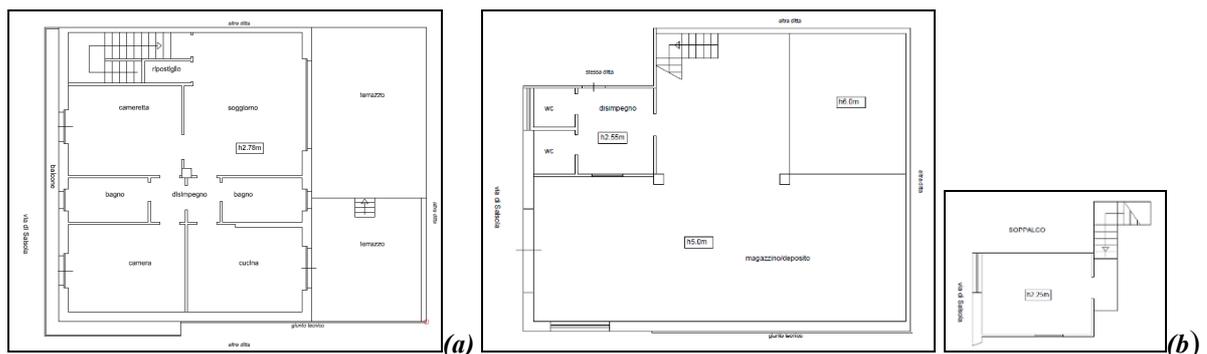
Planimetrie attuali degli immobili ubicati in via Di Salsola n° 149 e n° 149/A: abitazione in primo piano (a); locale a pianterreno (b).
